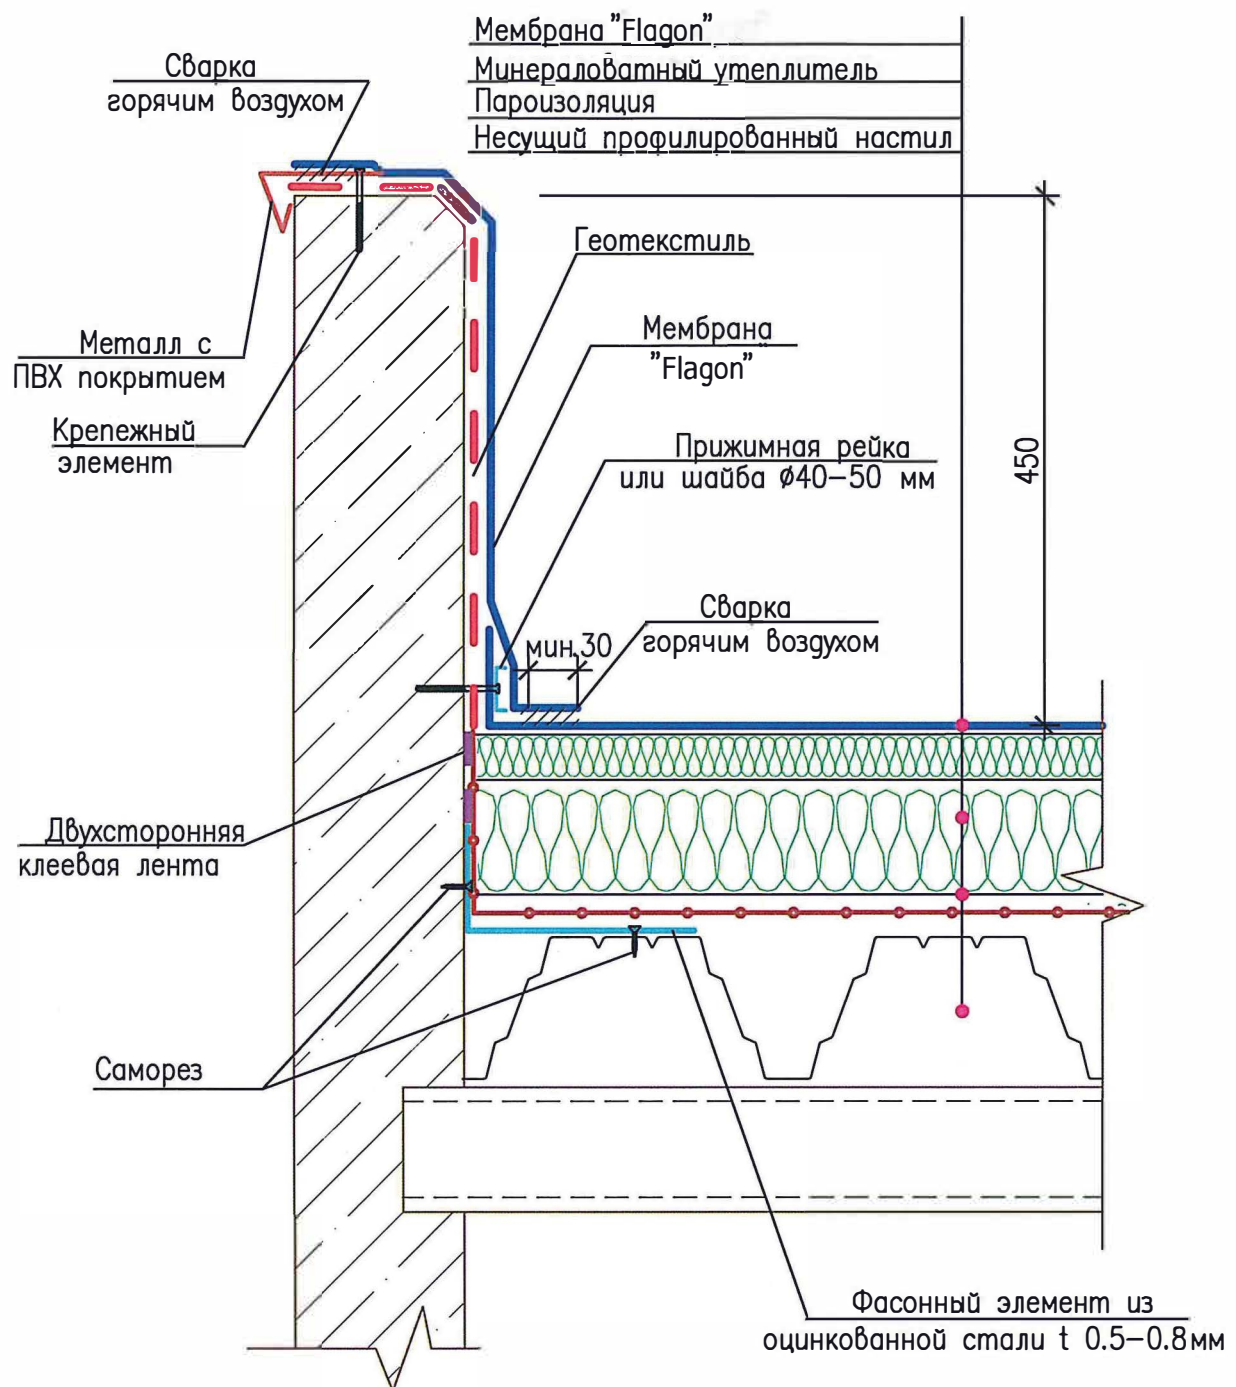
Конструктивные решения узлов для кровли с несущим профилированным настилом с механическим закреплением. Устройство примыкания к продольному парапету
